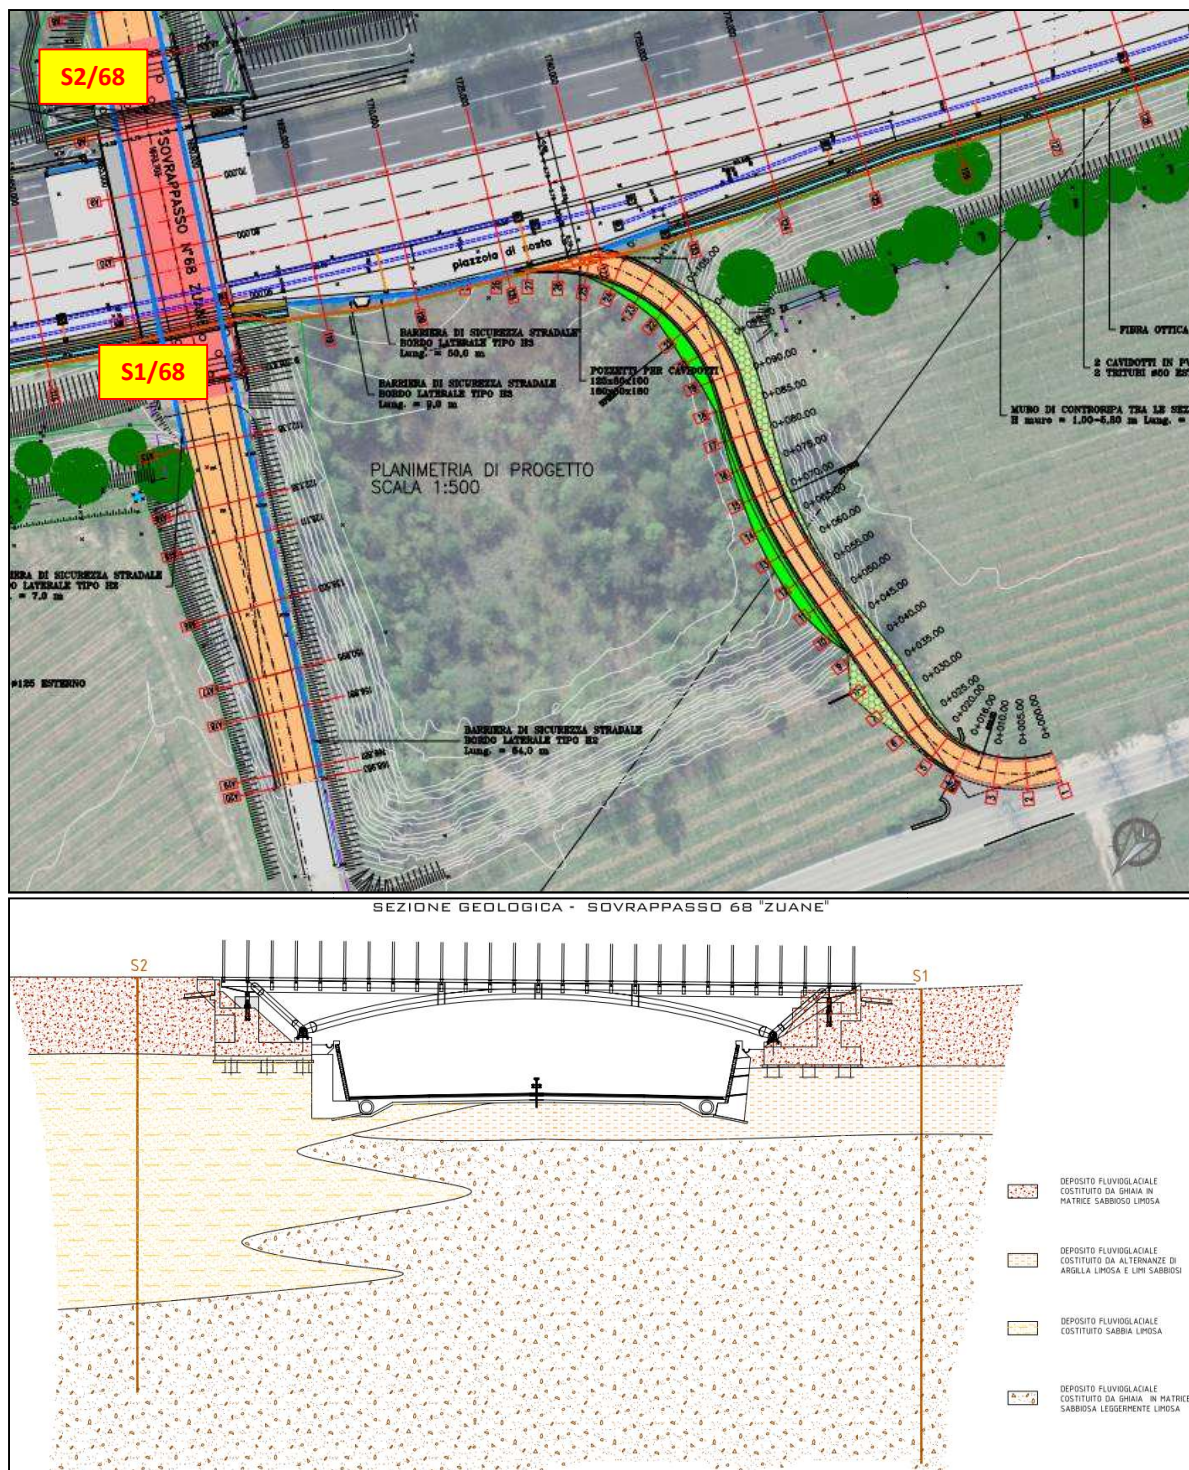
PLANIMETRIA DELLA PISTA DI ACCESSO DI EMERGENZA CON UBICAZIONE DEI SONDAZZI E SEZIONE GEOLOGICA INTERPRETATIVA
